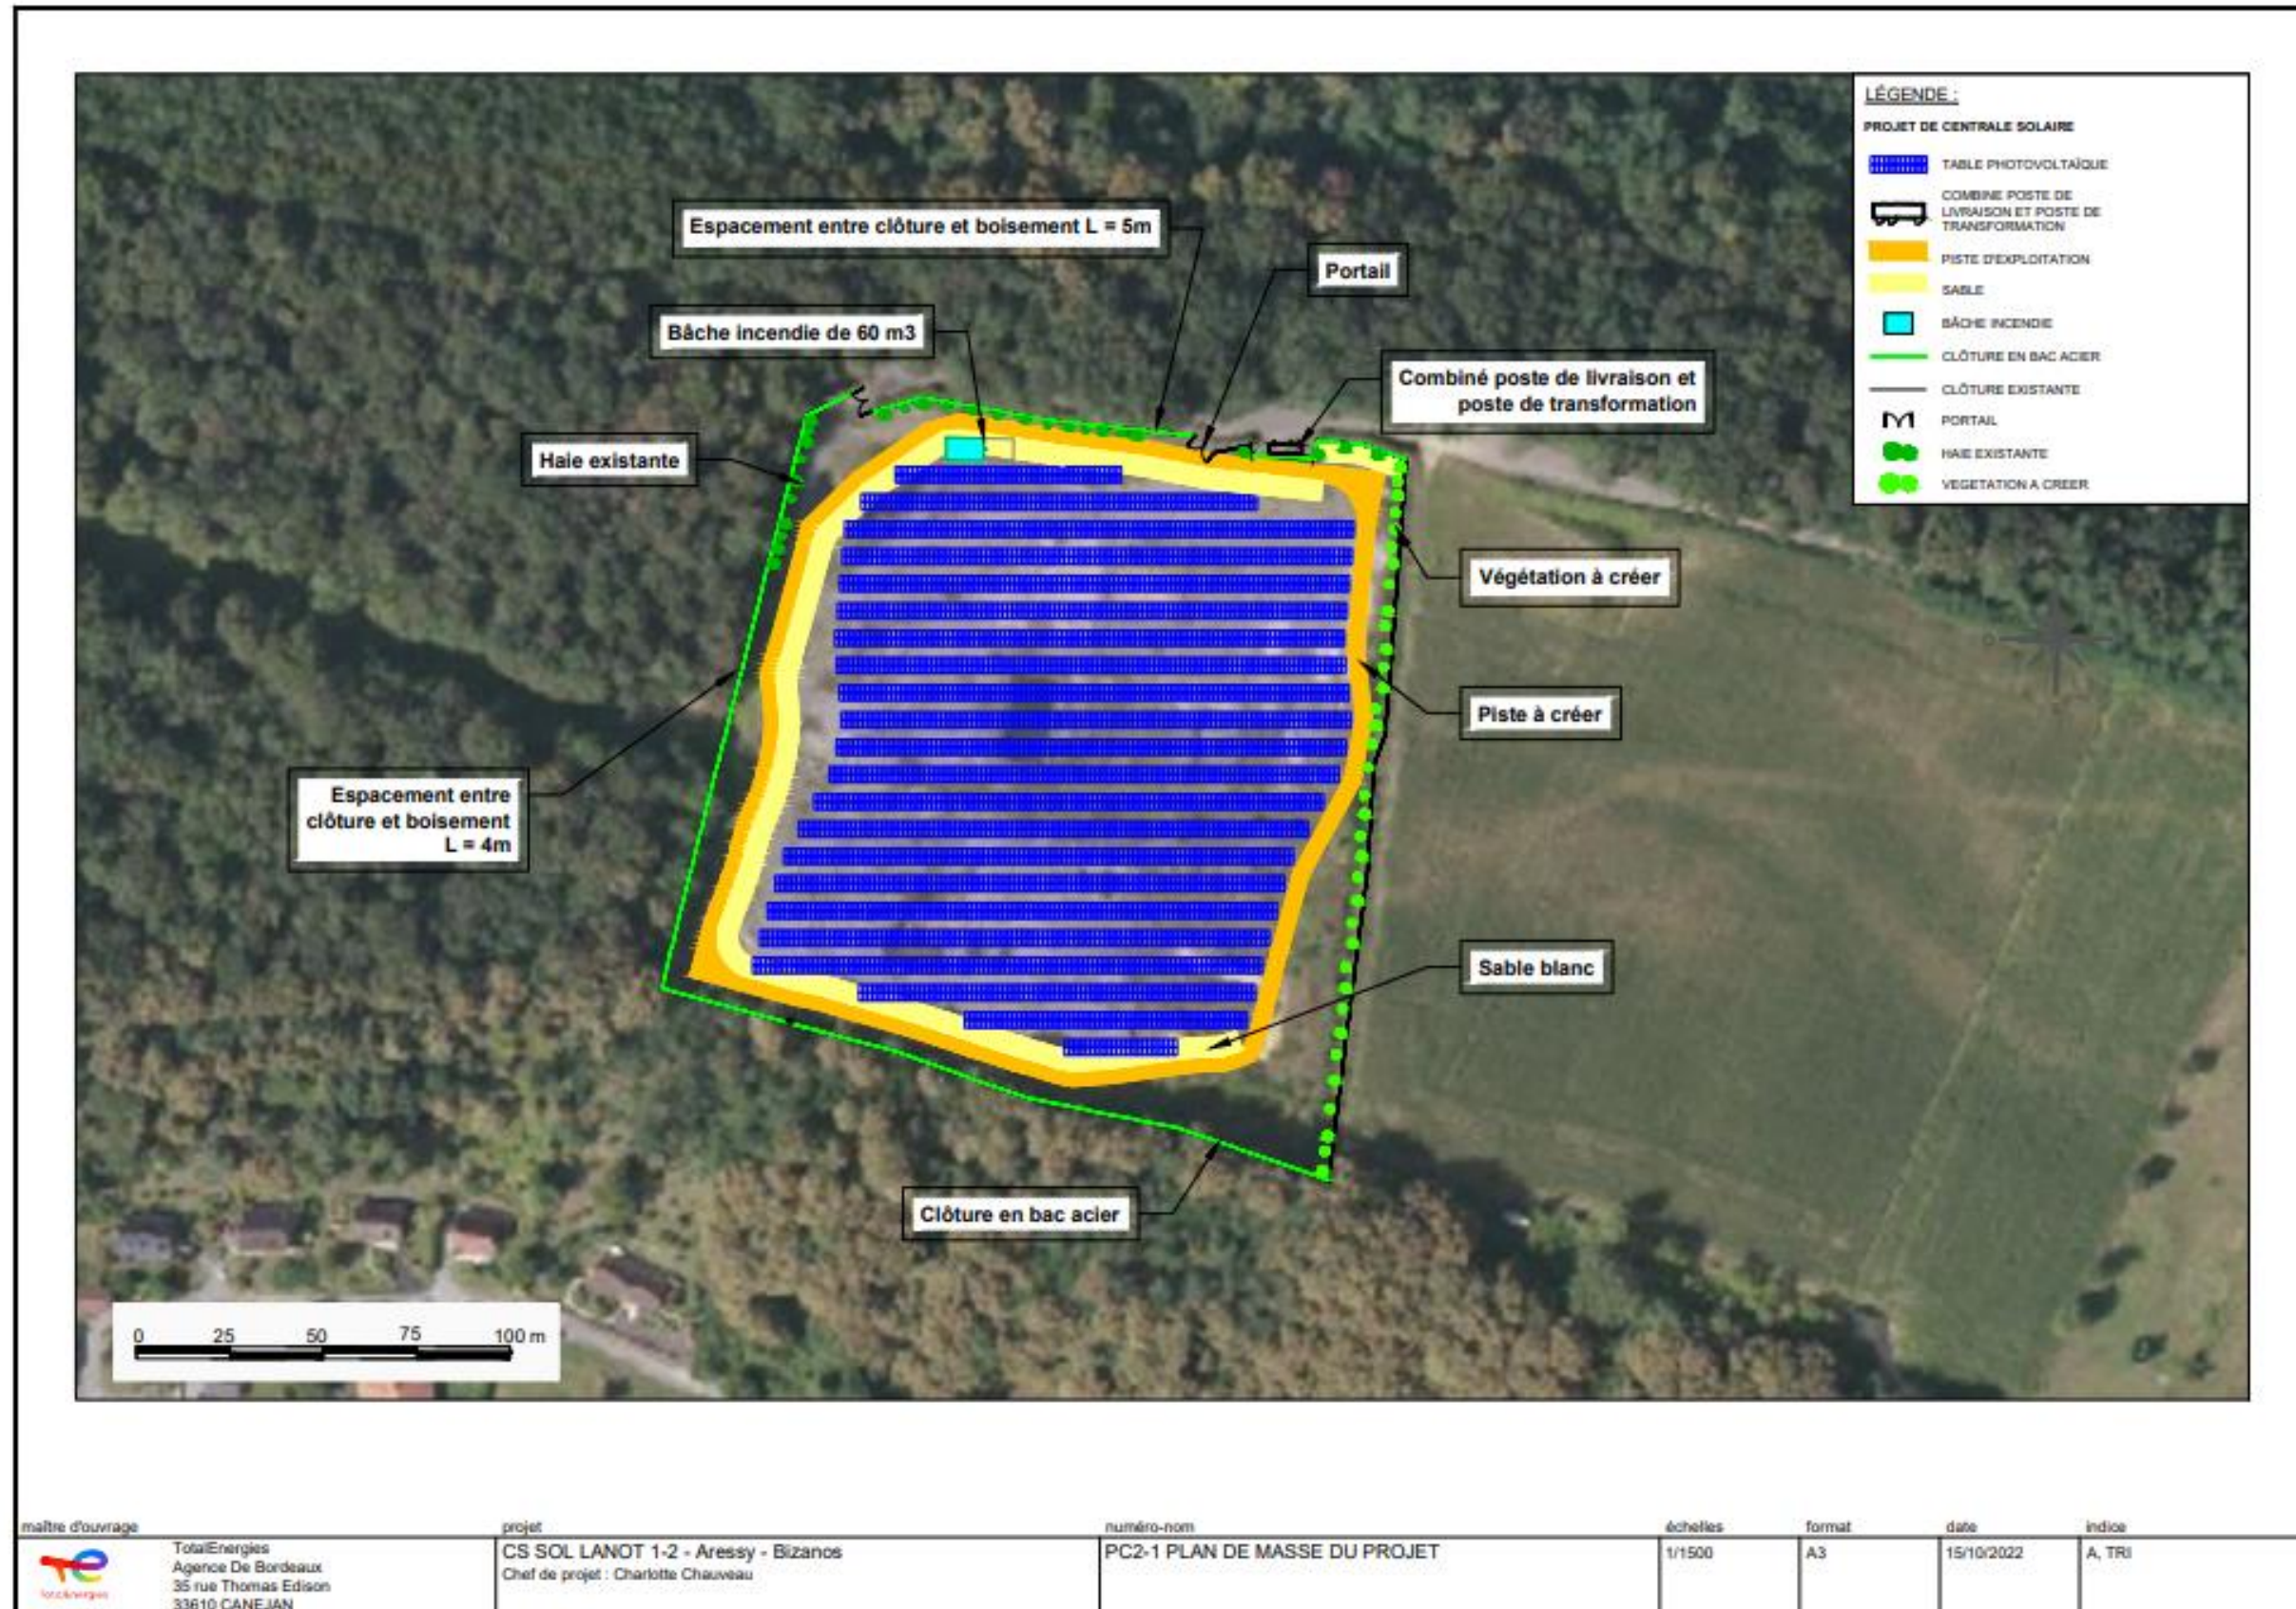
Plan de masse du site Lanot 1-2 (Bizanos / Aressy)
